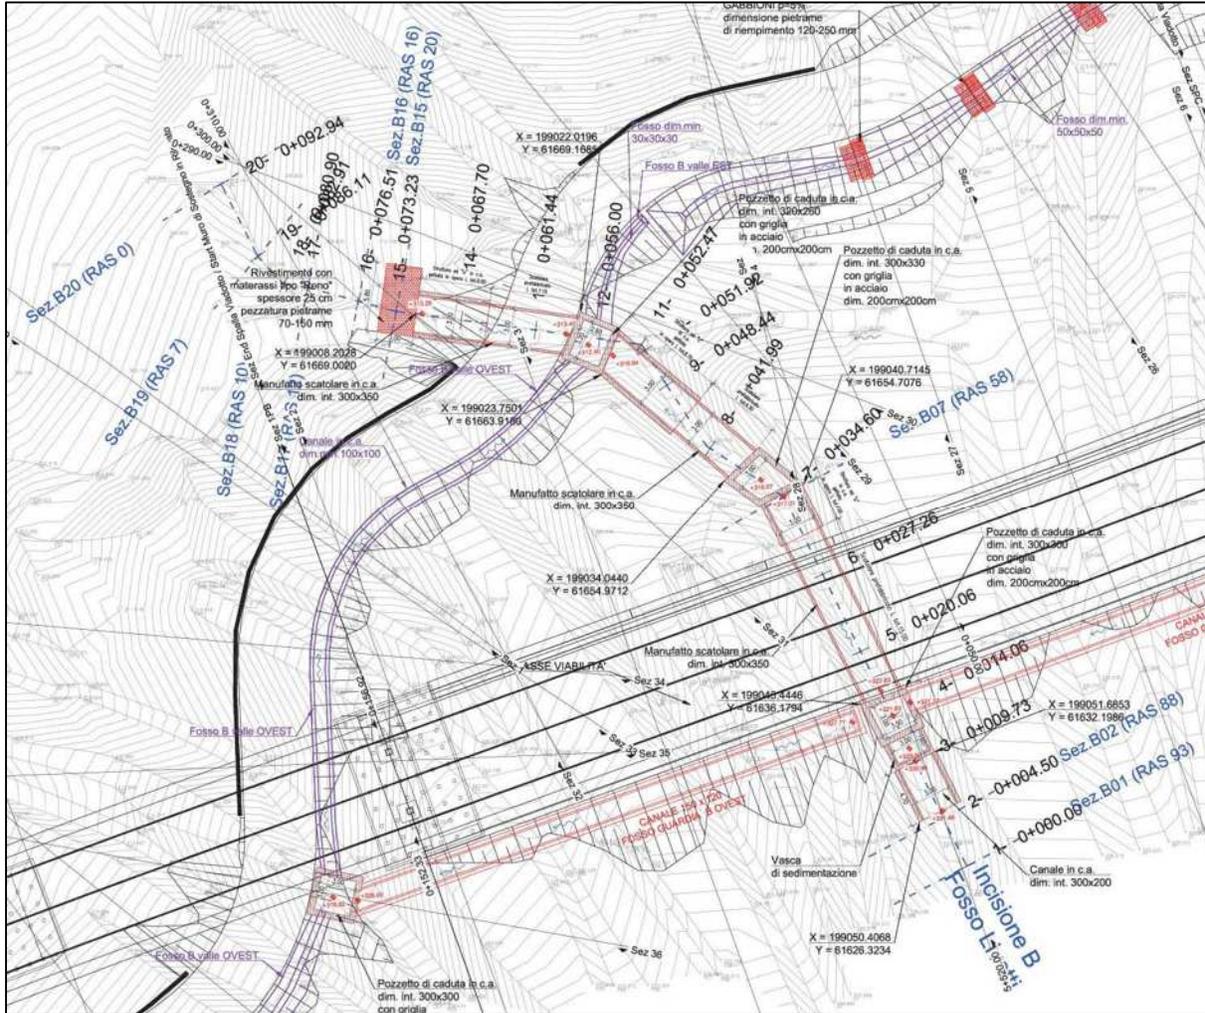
Incisione B – Planimetria e indicazione sezioni RAS
